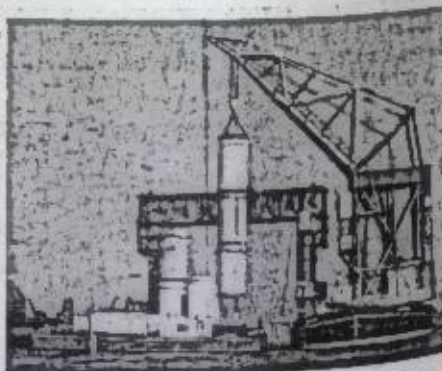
Сооружение фундамента опоры большого моста из сборных железобетонных оболочек диаметром 5 м.
